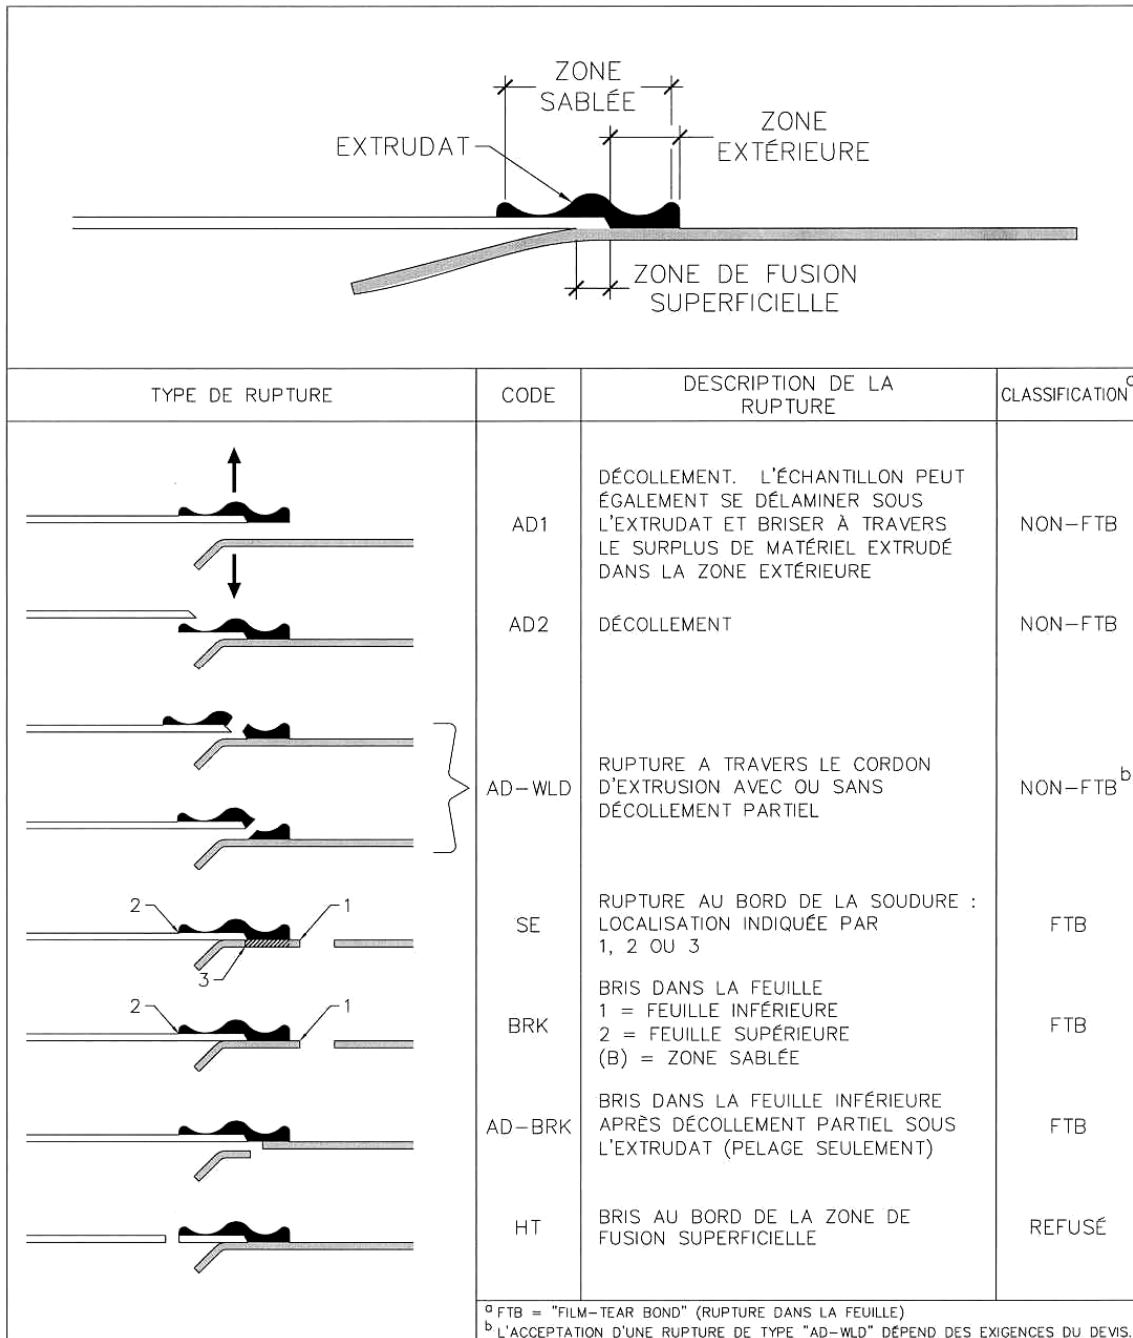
Types de rupture pour une soudure par extrusion.
